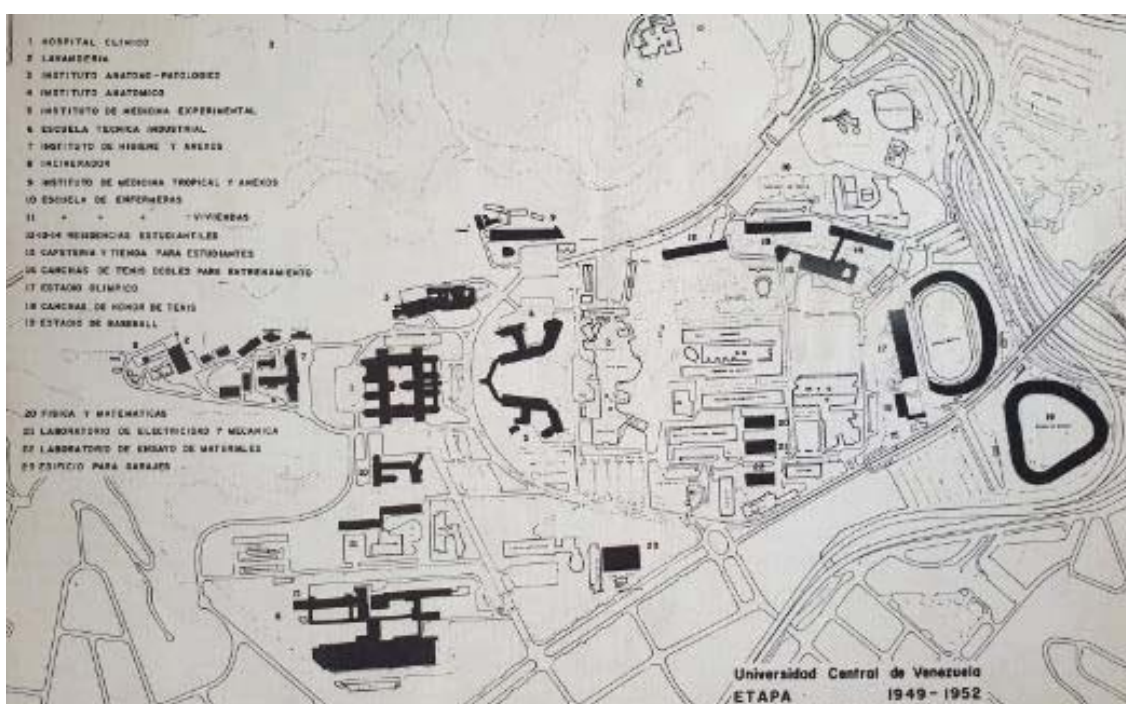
Plano del Conjunto de la UCV, resaltado en negro lo construido en la primera etapa.
